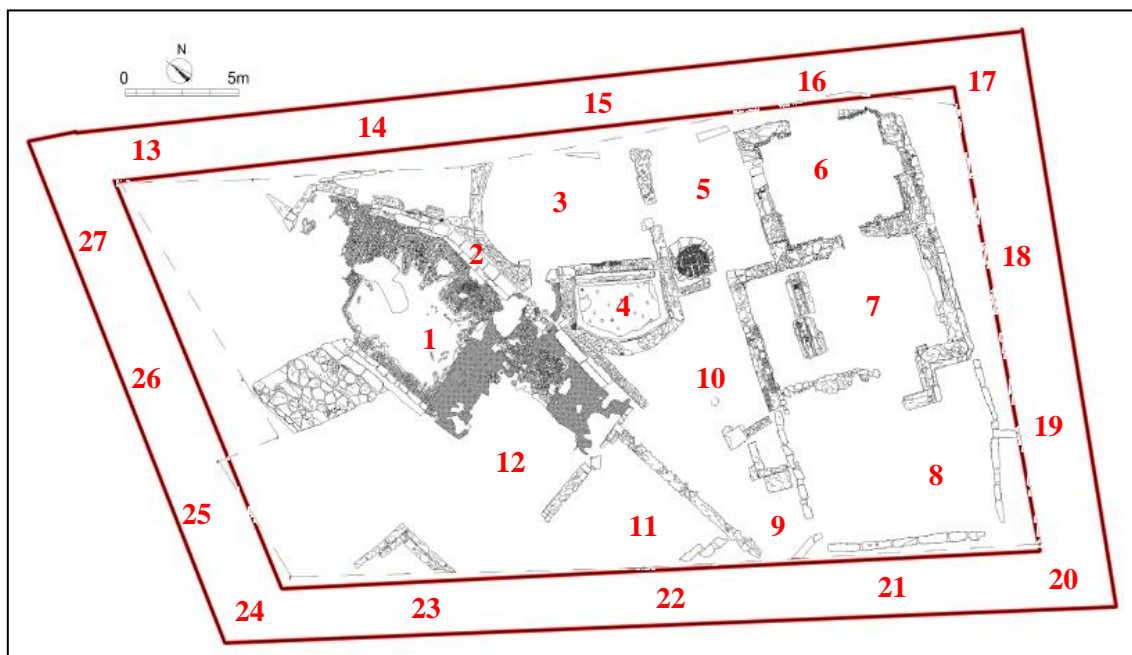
Planimetria delle terme con indicazione delle stazioni; il perimetro rosso indica la passerella (immagine modificata da Cassano 2009).
